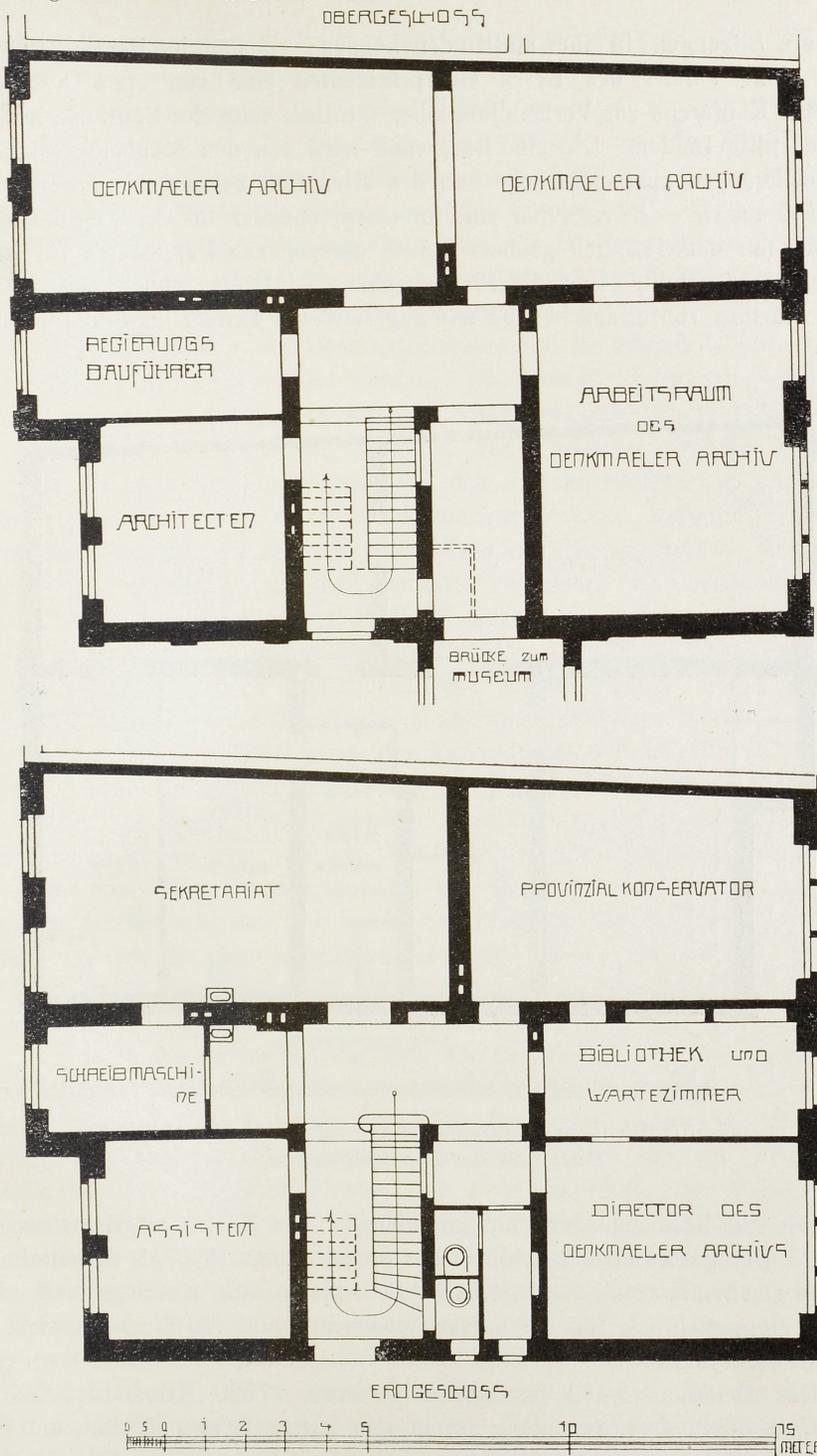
Bonn, Verwaltungsgebäude für die Denkmalpflege. Grundrisse des Erdgeschosses und des Obergeschosses.
